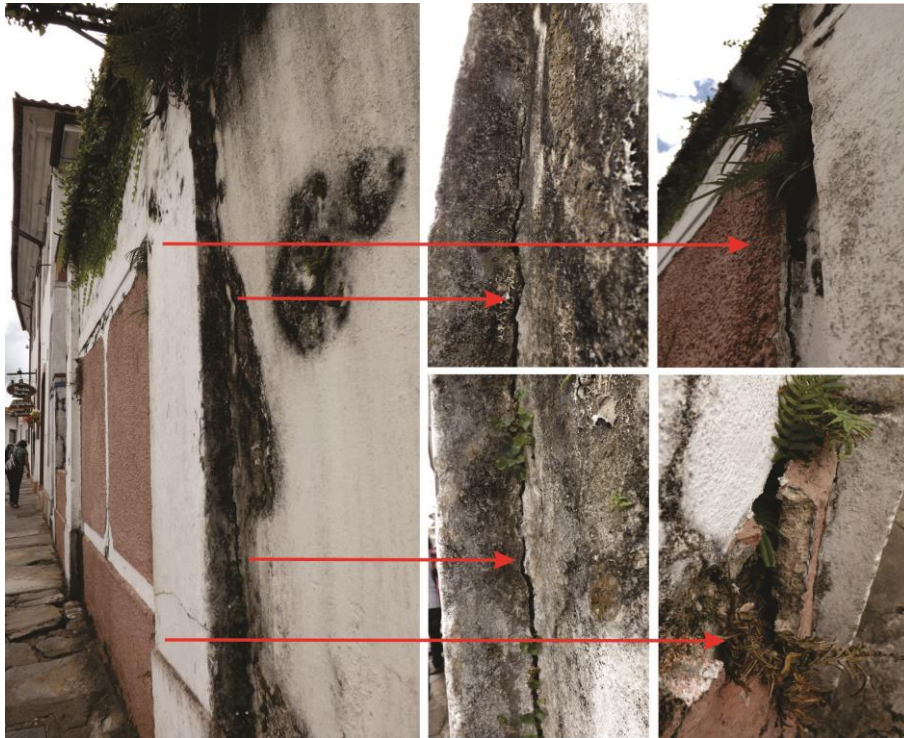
Área 2 – Patologias em estrutura de contenção caracterizadas por trincas e fissuras.
